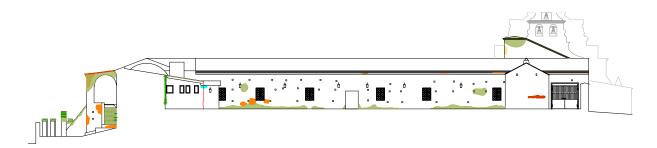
Relevamiento de lesiones - Fachada interna Oeste - Segundo Patio
